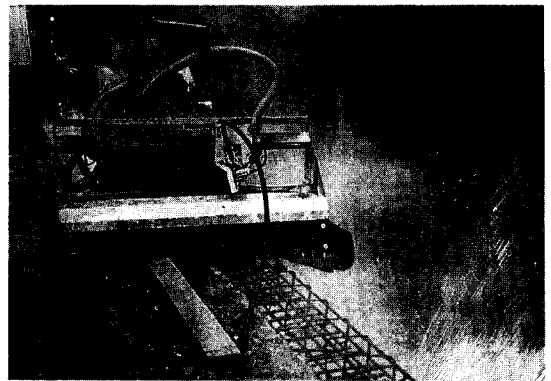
Water Jet에 의한 Capping Concrete 정리모습
